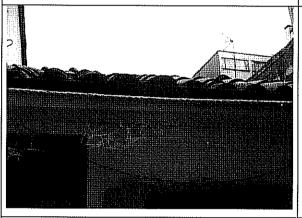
Cubierta de la parte posterior en buenas condiciones.
